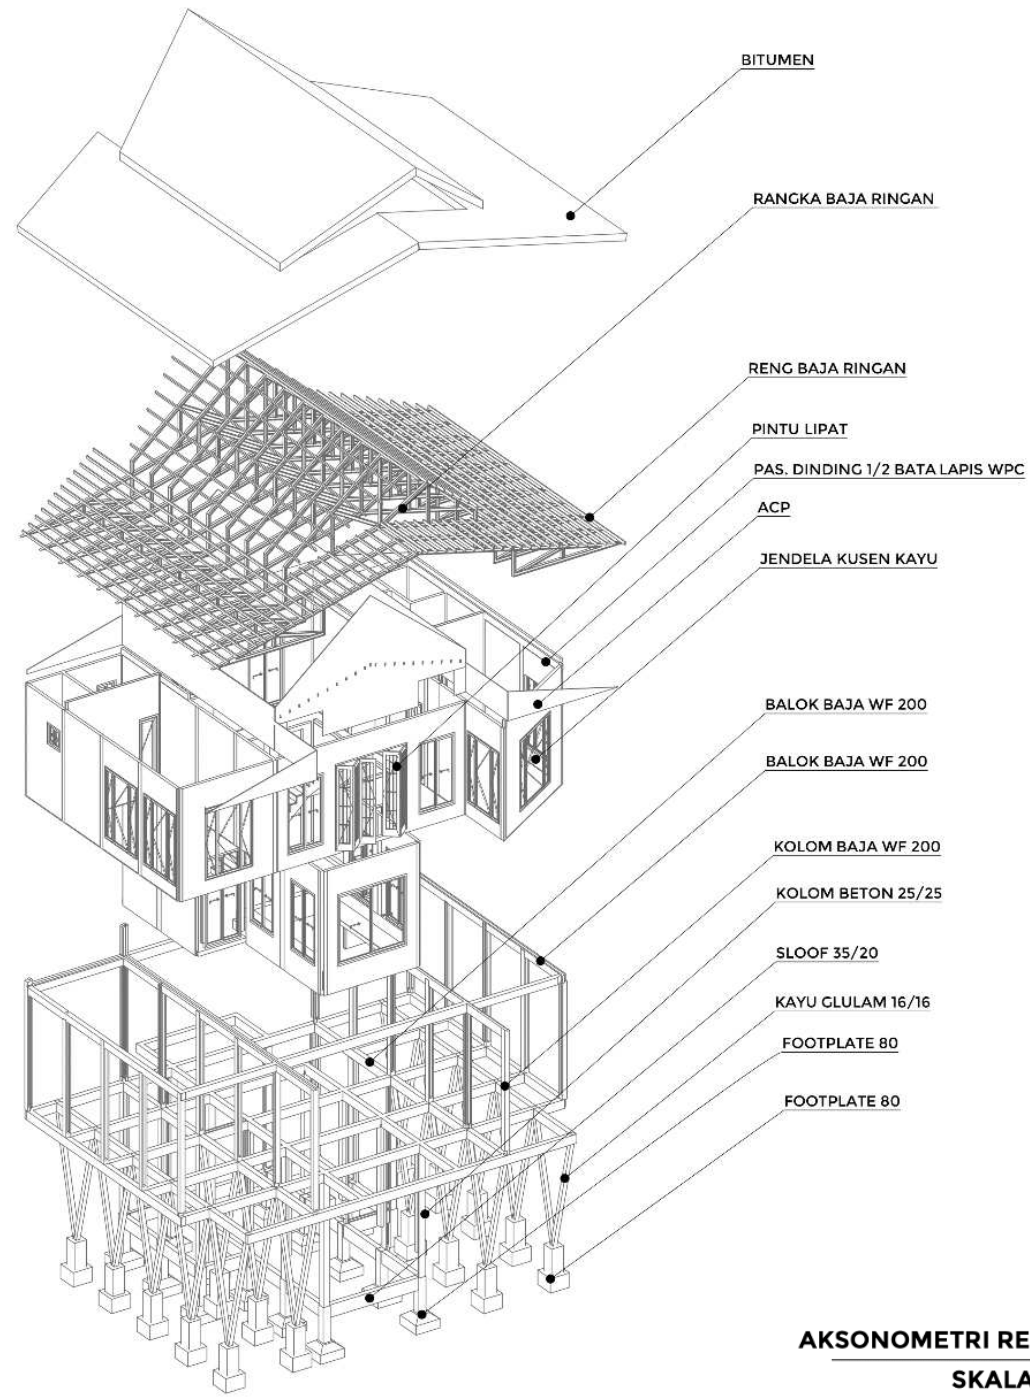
Rencana Pondasi dan Kolom Balok Hotel
